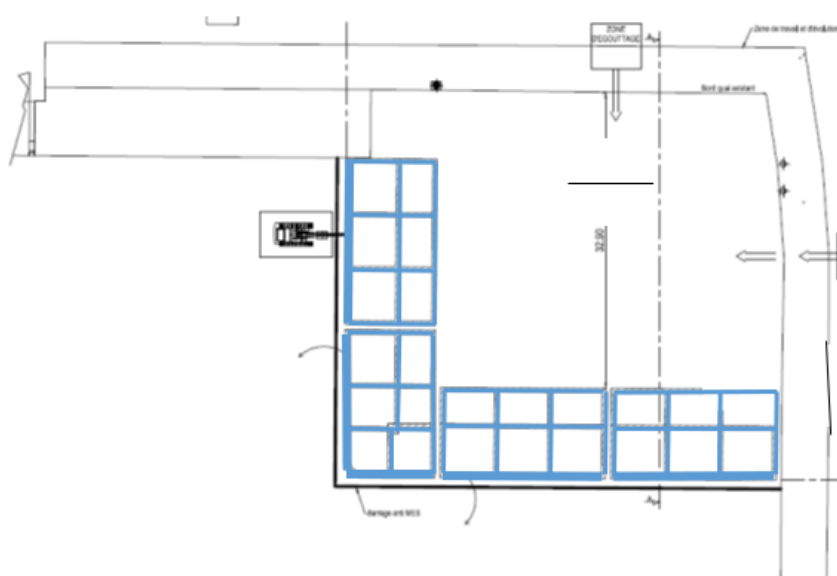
Phase 5 – Vue en plan – Démontage des voiles des quatre caissons – Levage par moyens nautiques
